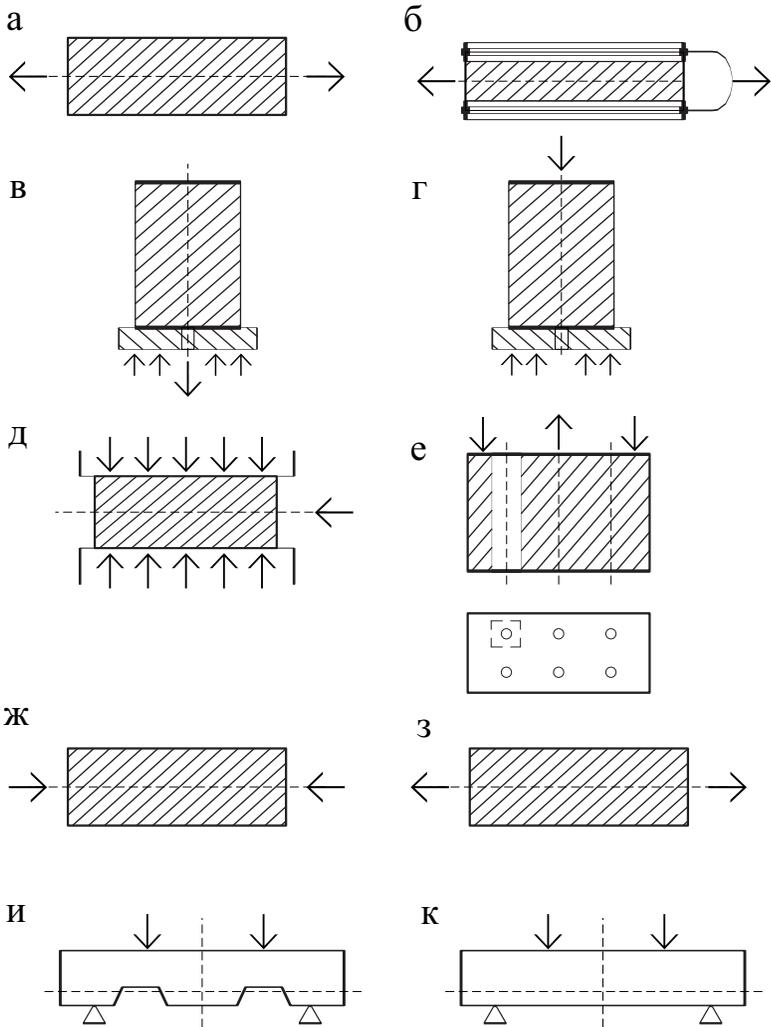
Схемы испытания сцепления арматуры с бетоном
